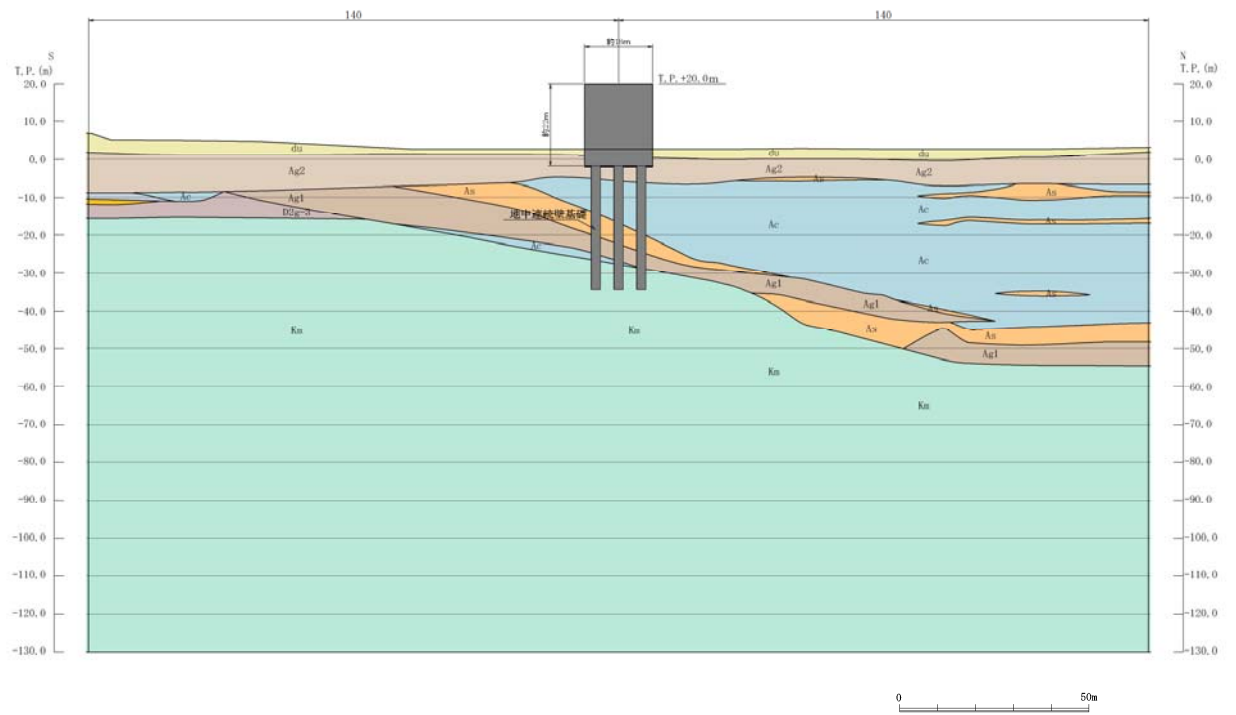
(3) 鉄筋コンクリート防潮壁 評価対象断面図 (③-③断面)
